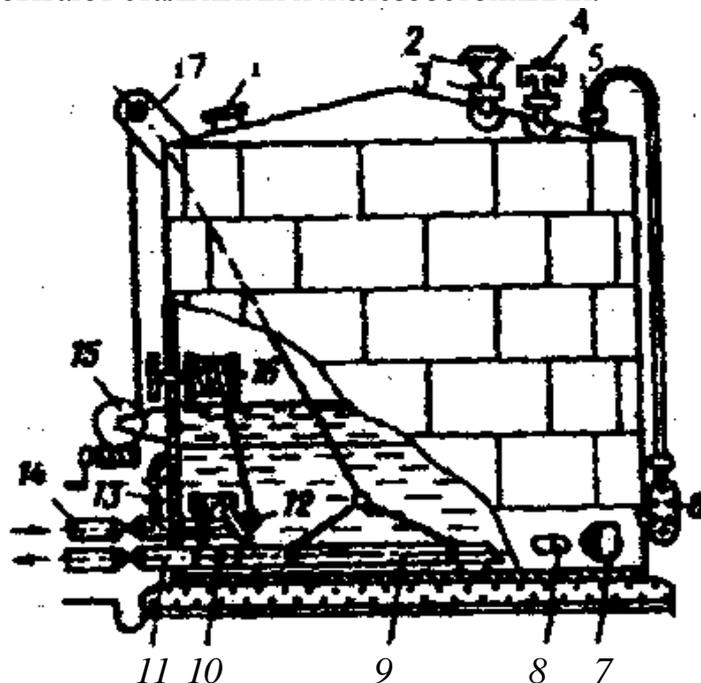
Вертикальный цилиндрический резервуар:
